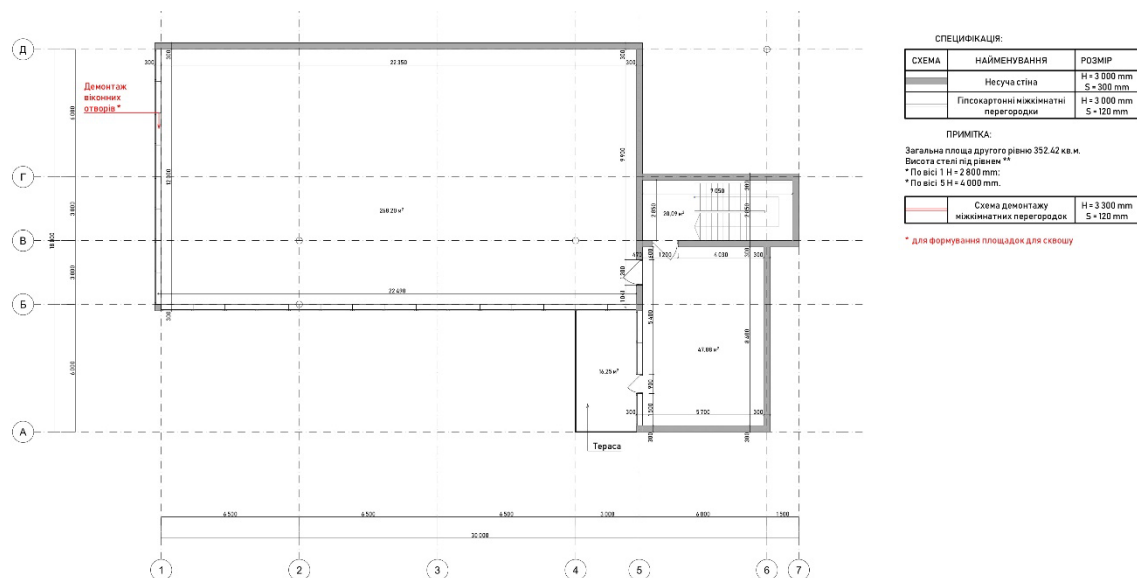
Схема демонтажу міжкімнатних перегородок другого рівню
